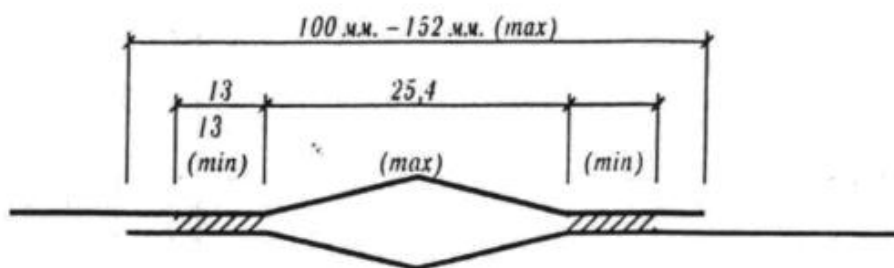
Сварка геомембраны контактной сваркой
